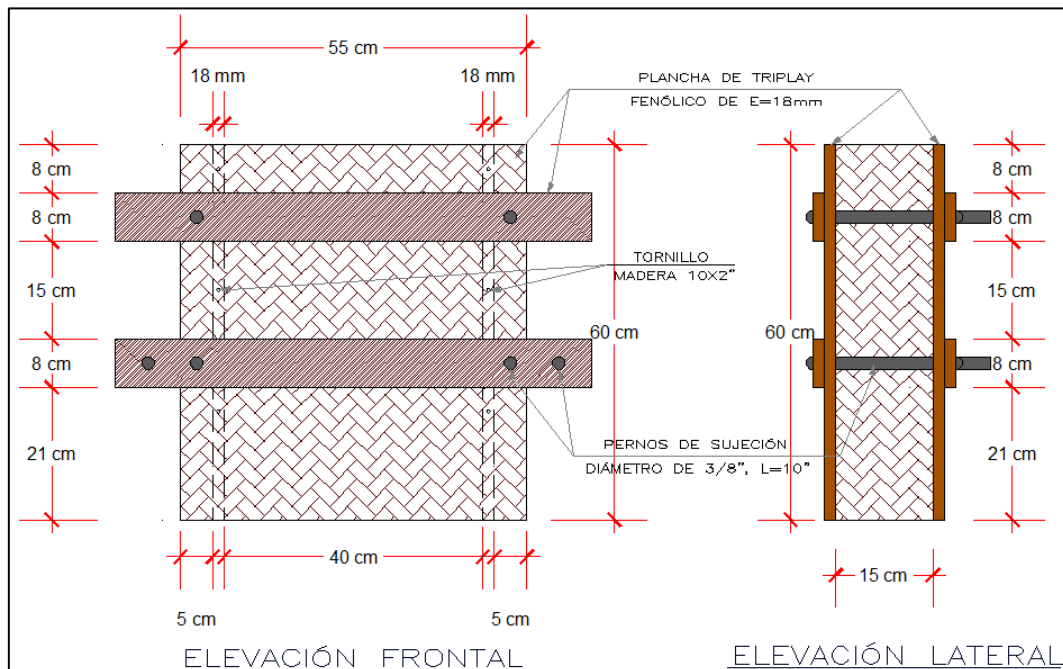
Elevación frontal y lateral del encofrado para la construcción de muretes.
